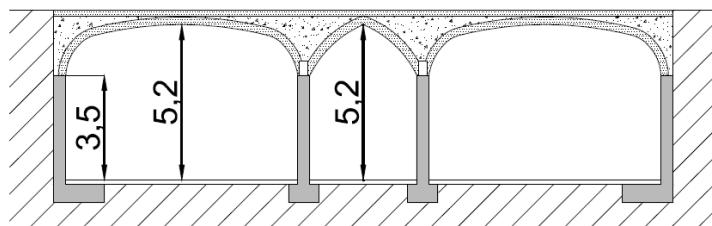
Vista simplificada de la secció B-B' del Plànol 12. Vistes en planta i alçat de la nova edificació.
